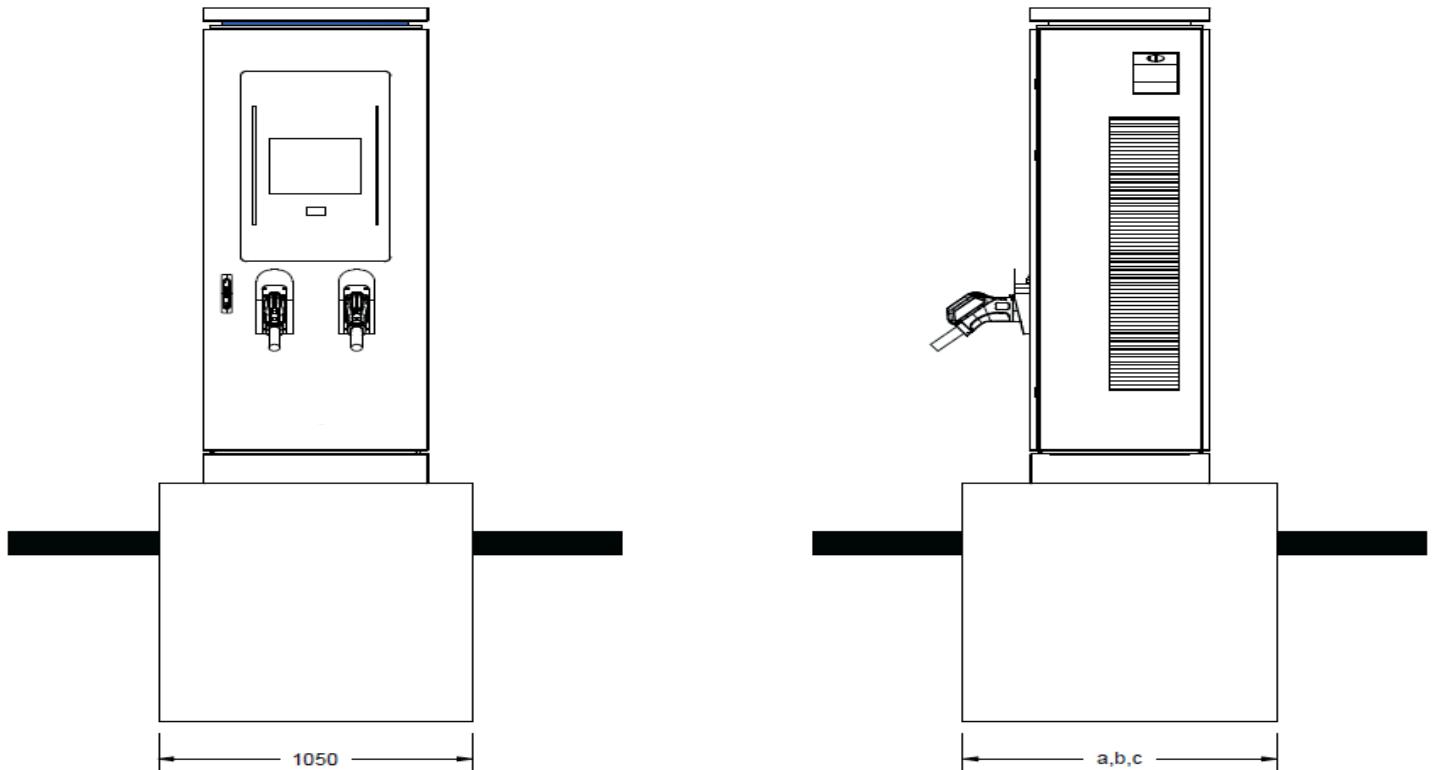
A Beton Kaidenin Üst Görünümü ve Kesidi
